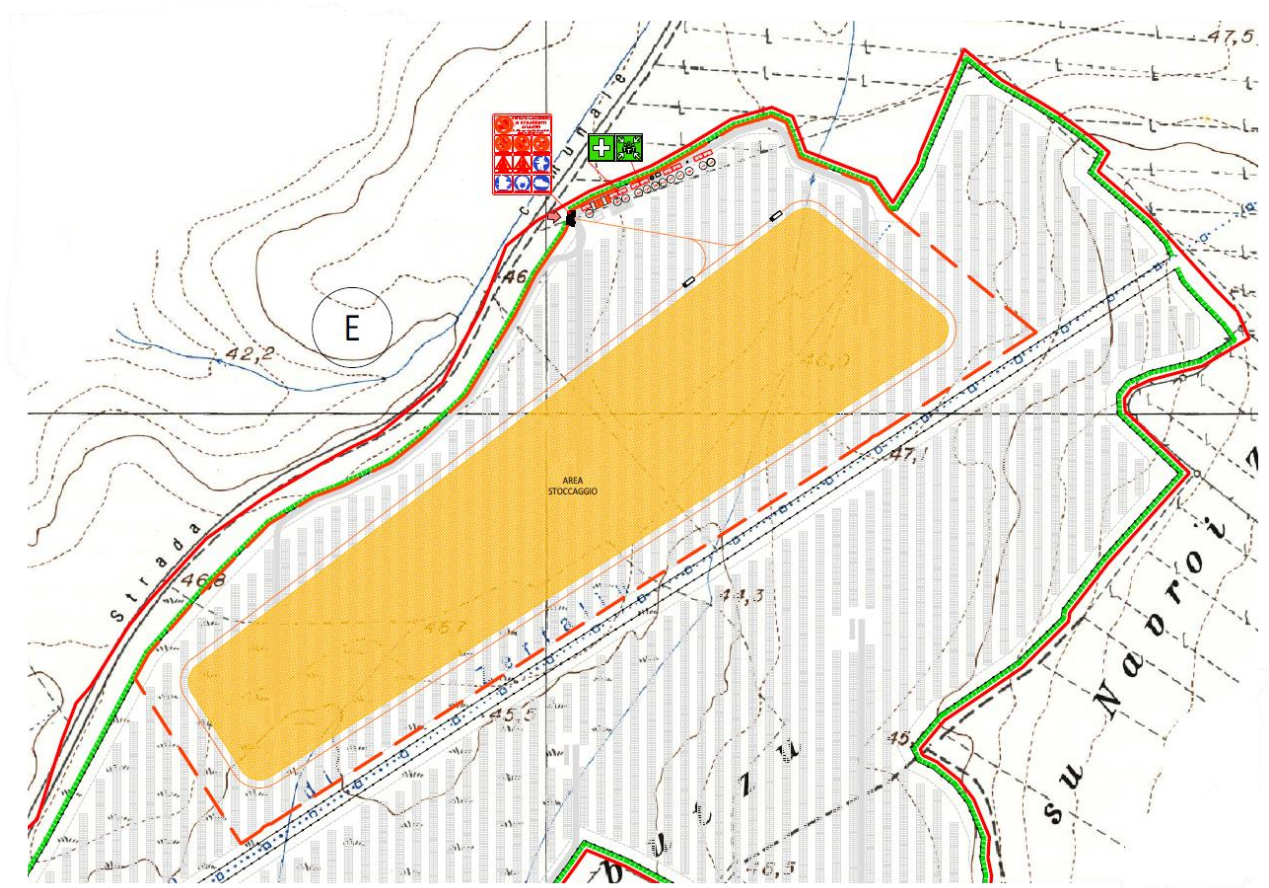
Stralcio delle aree di stoccaggio di cantiere sito Nord.
